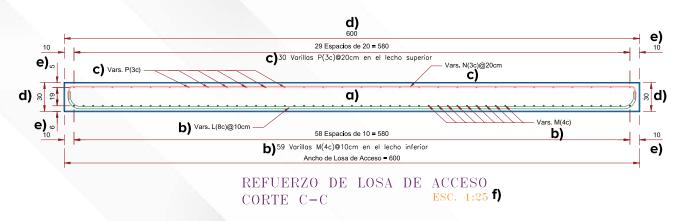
Ejemplo refuerzo de la losa de acceso, corte C-C
